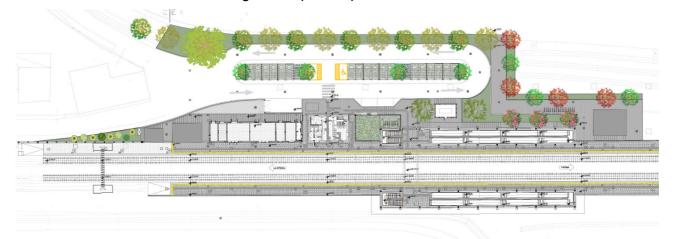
ESTRATTO PLANIMETRIA DI BANCHINA
